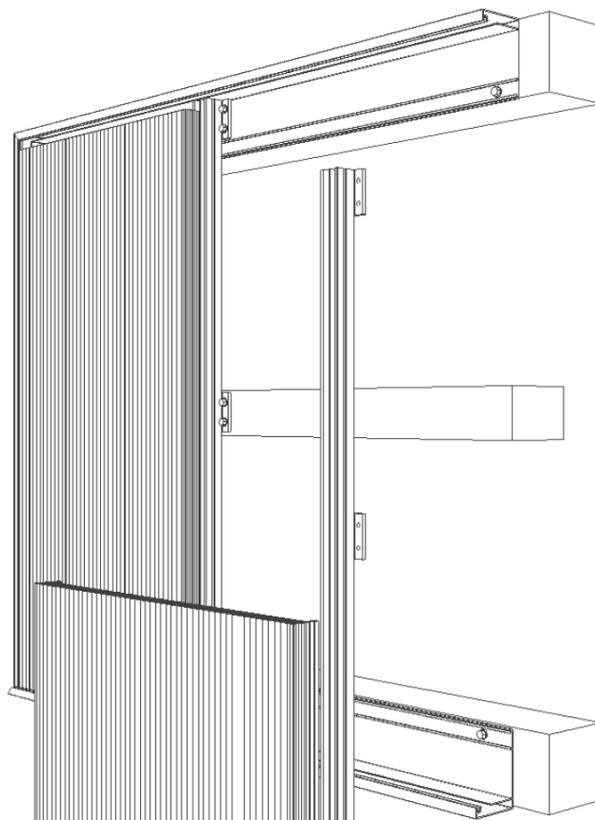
Installation BDL25 (connecteur en aluminium)
